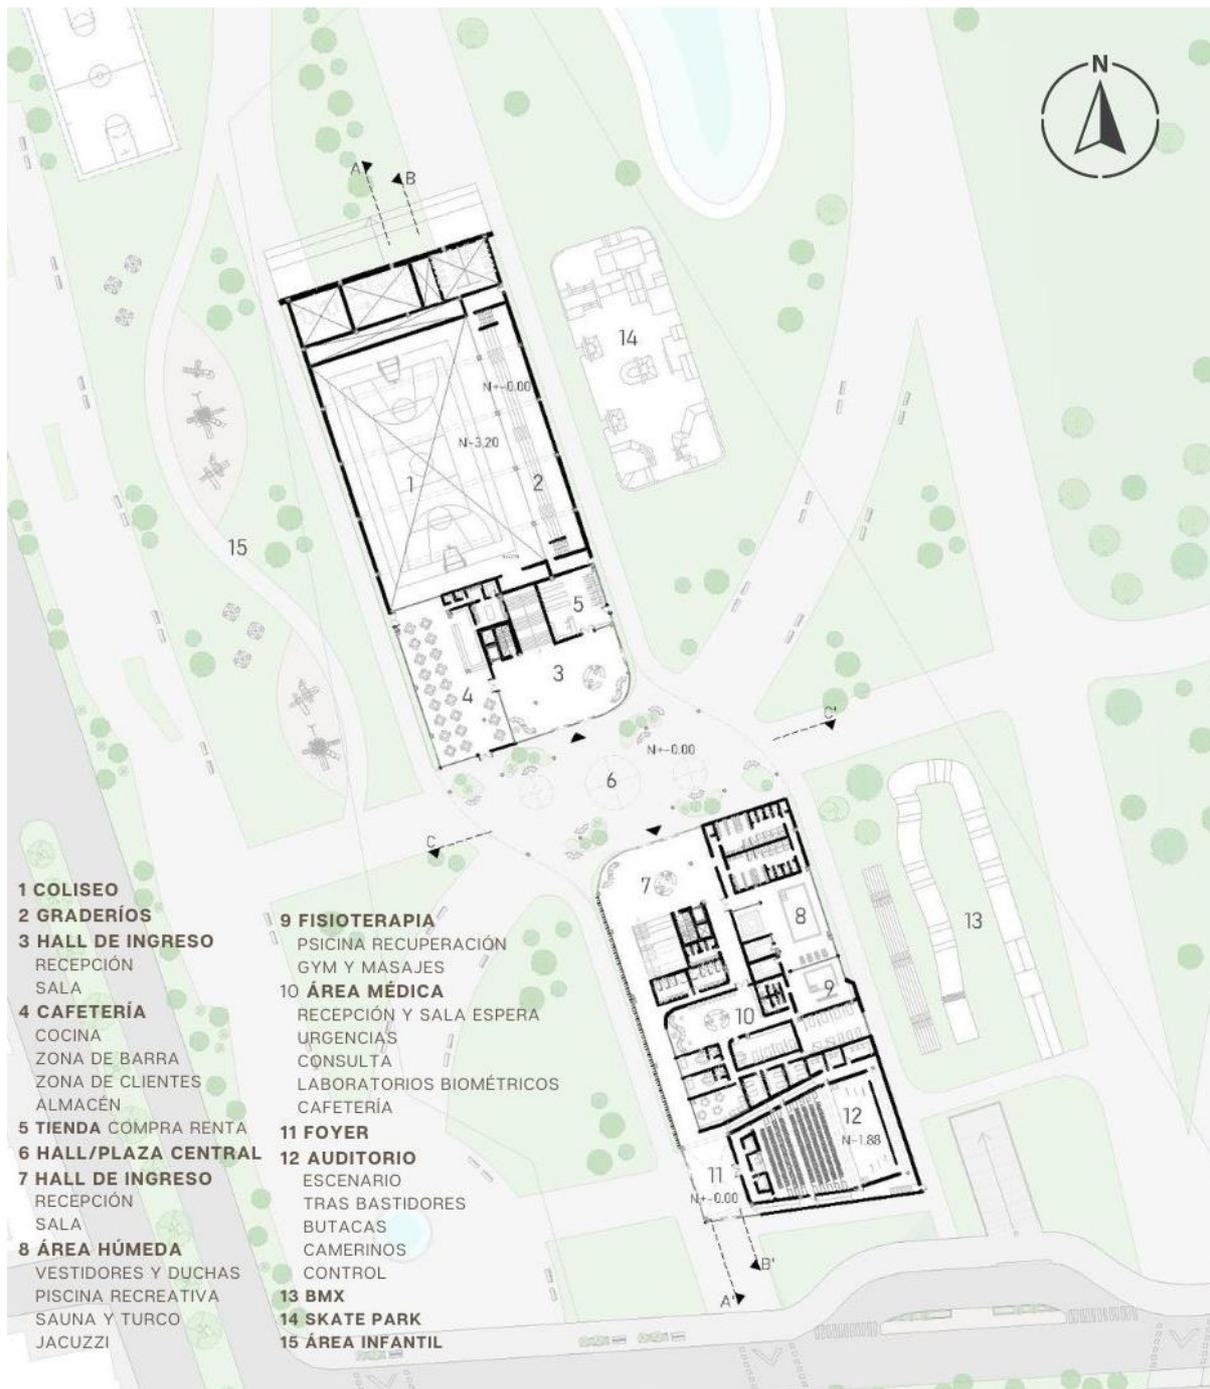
Planta baja Centro Deportivo. Elaboración propia
